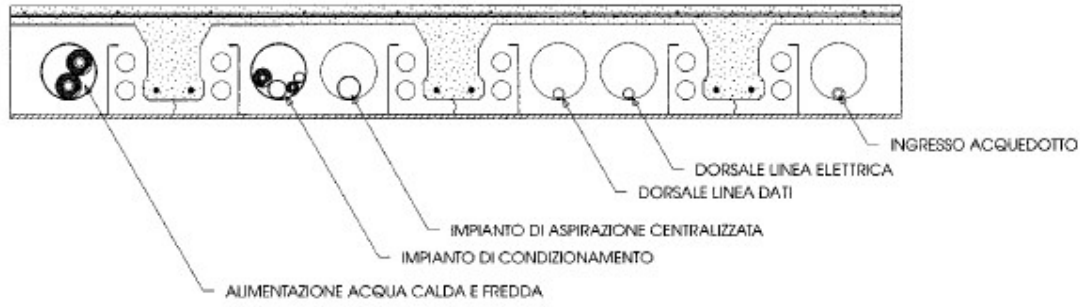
Dettaglio del solaio Plastbau Metal.
